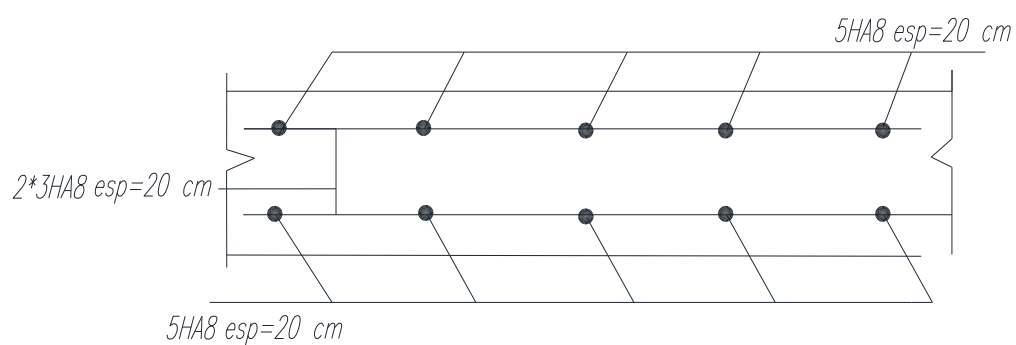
Coupe vertical de Ferrailage de l'acrotère
